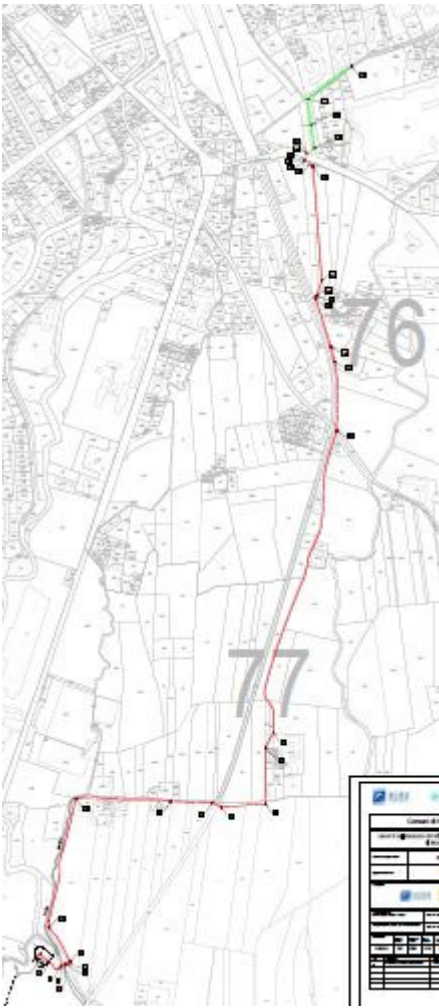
Planimetria catastale del tracciato (estratto da Progetto).
